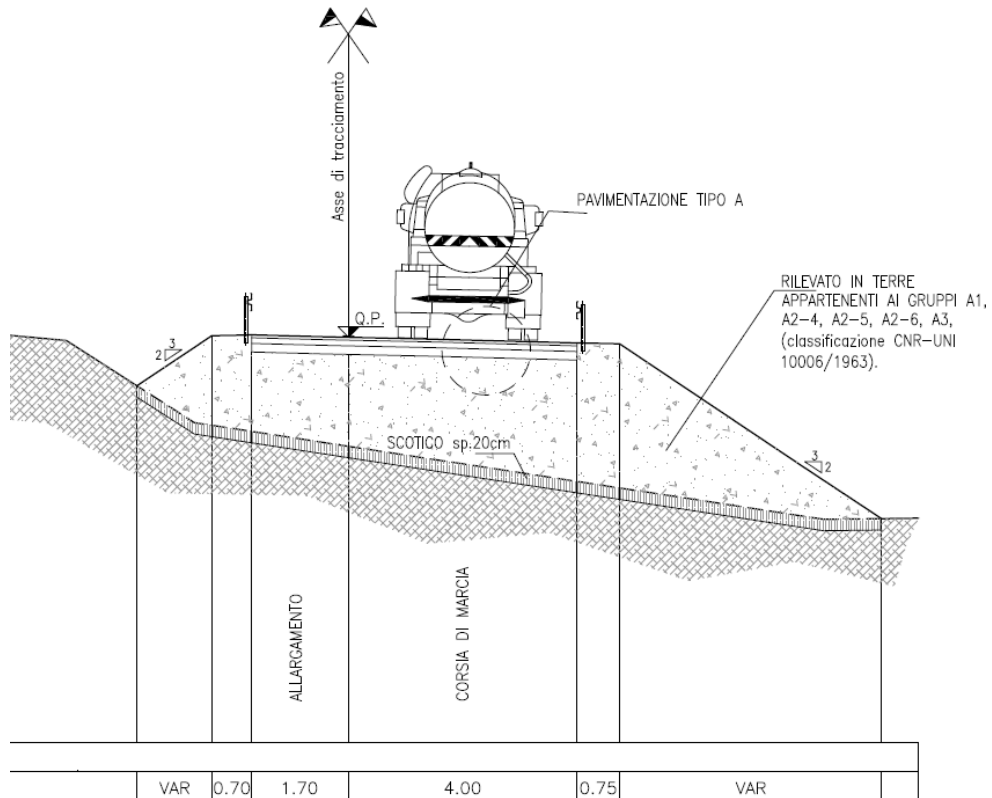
Sezione tipo strada di cantiere/security (rilevato)
